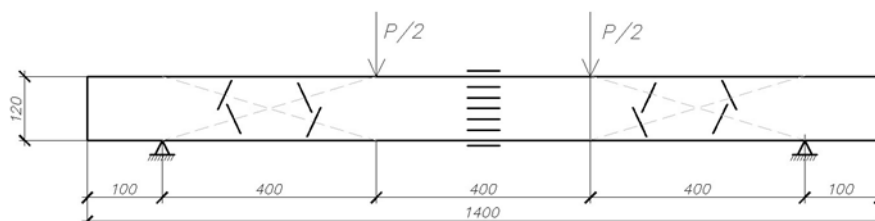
Схема размещения тензодатчиков на опытных балках первой серии для проведения испытаний на изгиб
